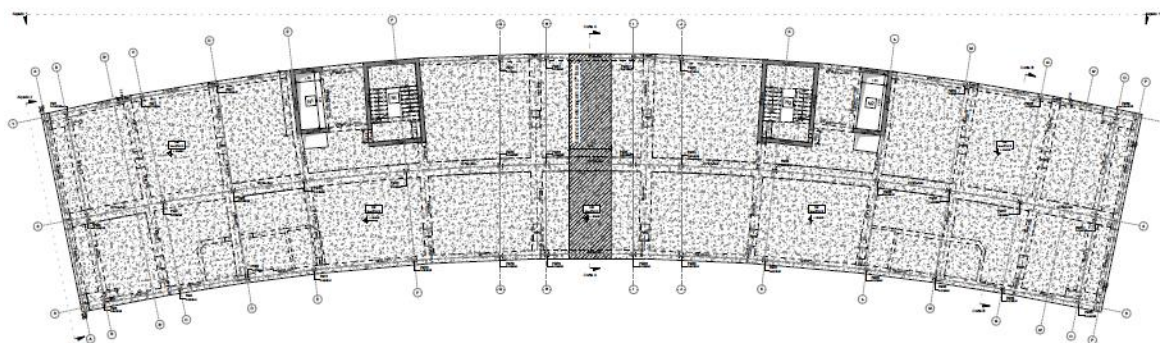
Planta do piso 1 associado à 2ª fase da obra. [SE2P]
